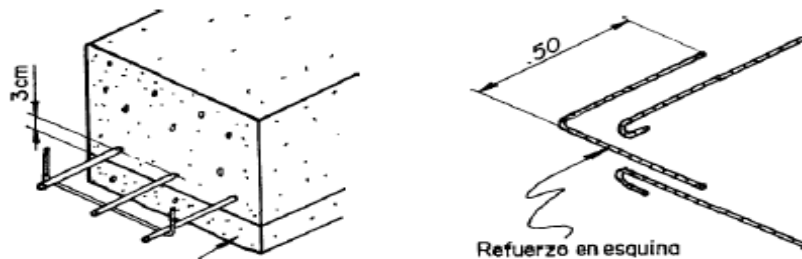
viga de fundación y refuerzo de varillas de acero #3 y #4 (3/8 y 1/4 pulgada)
